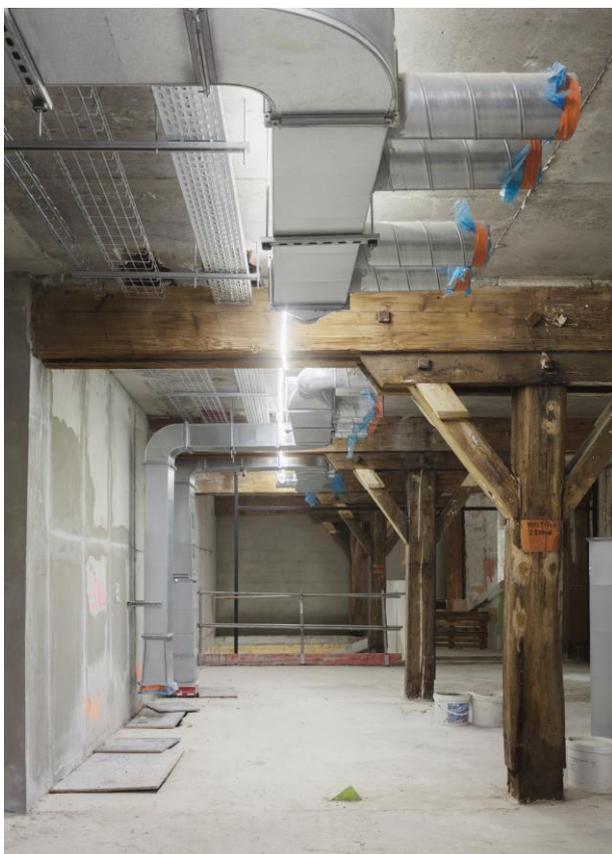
La structure bois support des planchers béton. © Schnepf Renou
